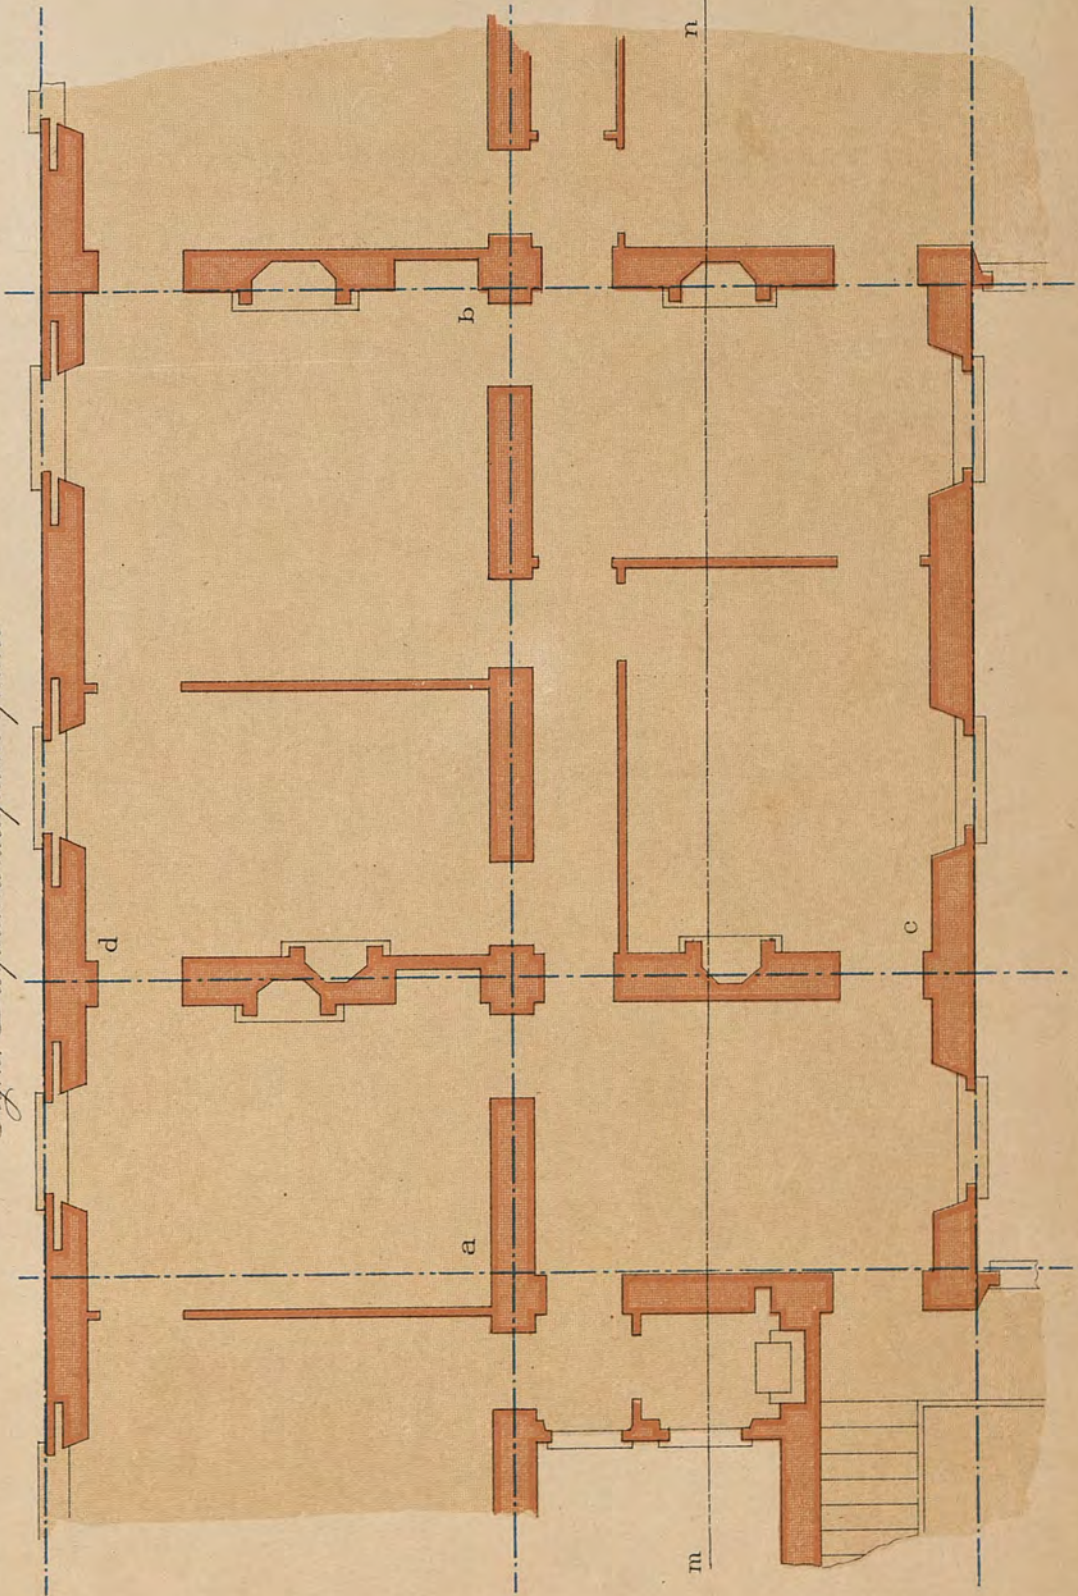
La pianta delle travi dei muri e delle travi armate dell'impalcatura
